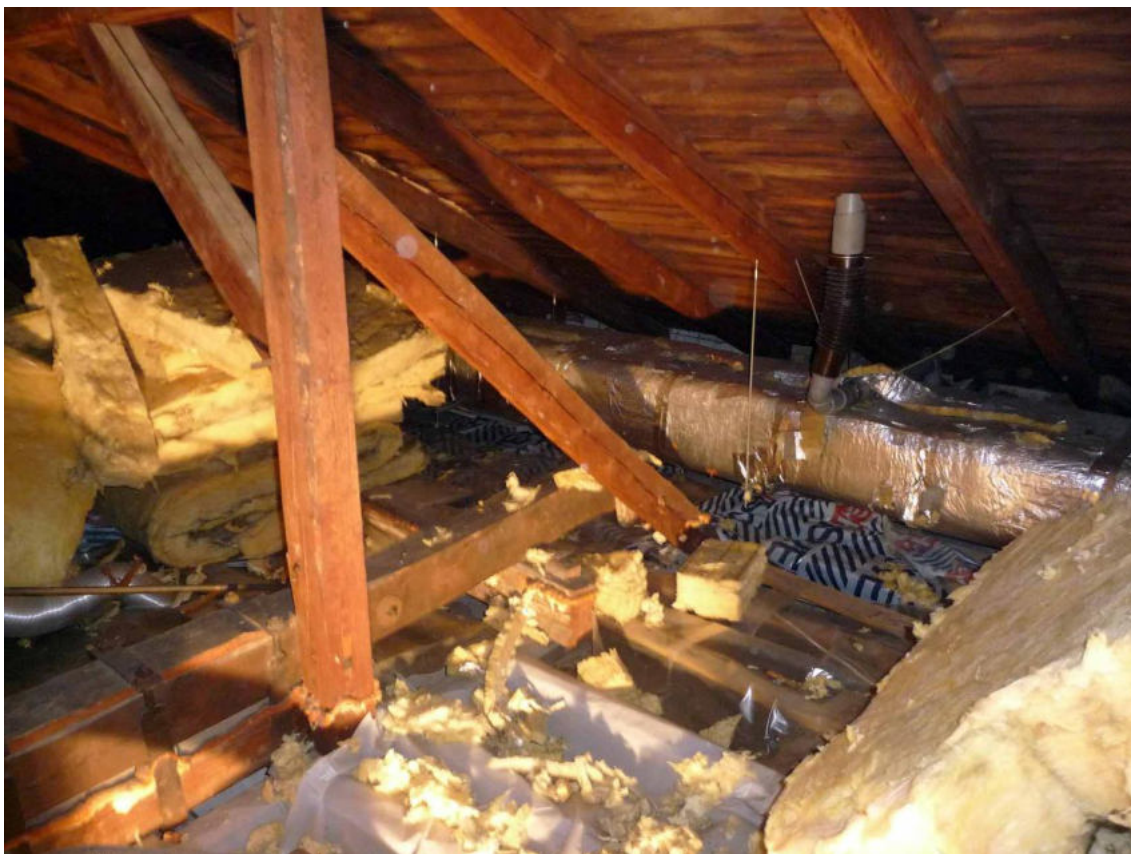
Blick in den Traufbereich der Dachkonstruktion des Hauptgebäudes;
